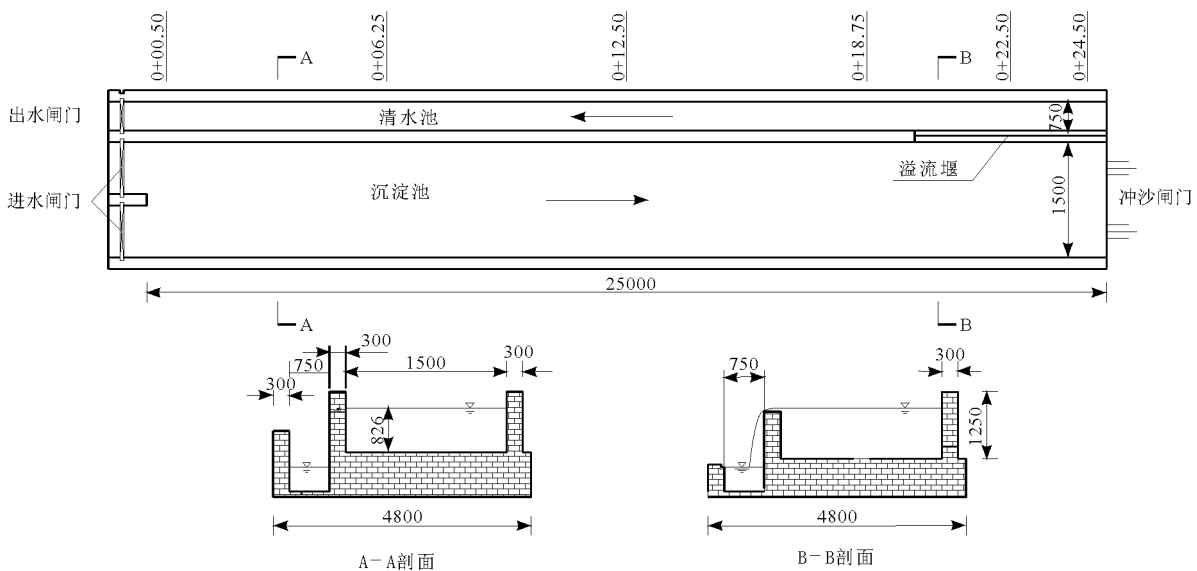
重力沉沙过滤池平面及断面图(桩号单位:m,标注单位:mm)
